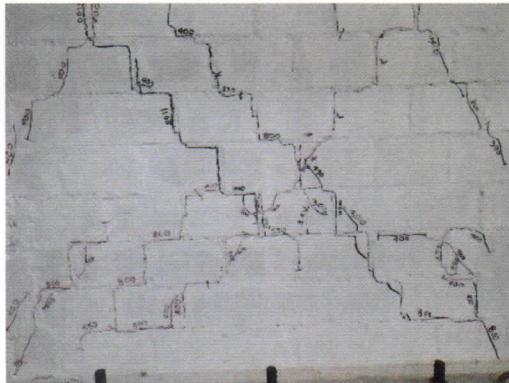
Aparición de pequeñas grietas (en su mayoría continuaciones de grietas diagonales anteriores) en la parte central de la cara Sur para una distorsión de 1/300.
